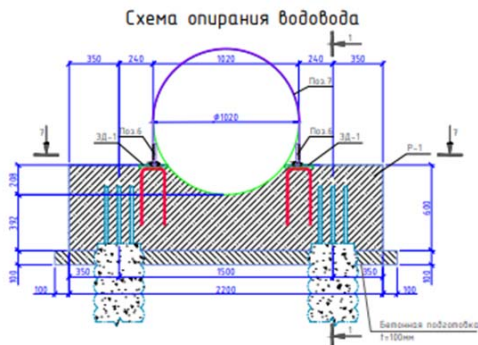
Узел передачи нагрузки от напорного трубопровода $d=1020,0$ мм на монолитный железобетонный ростверк
